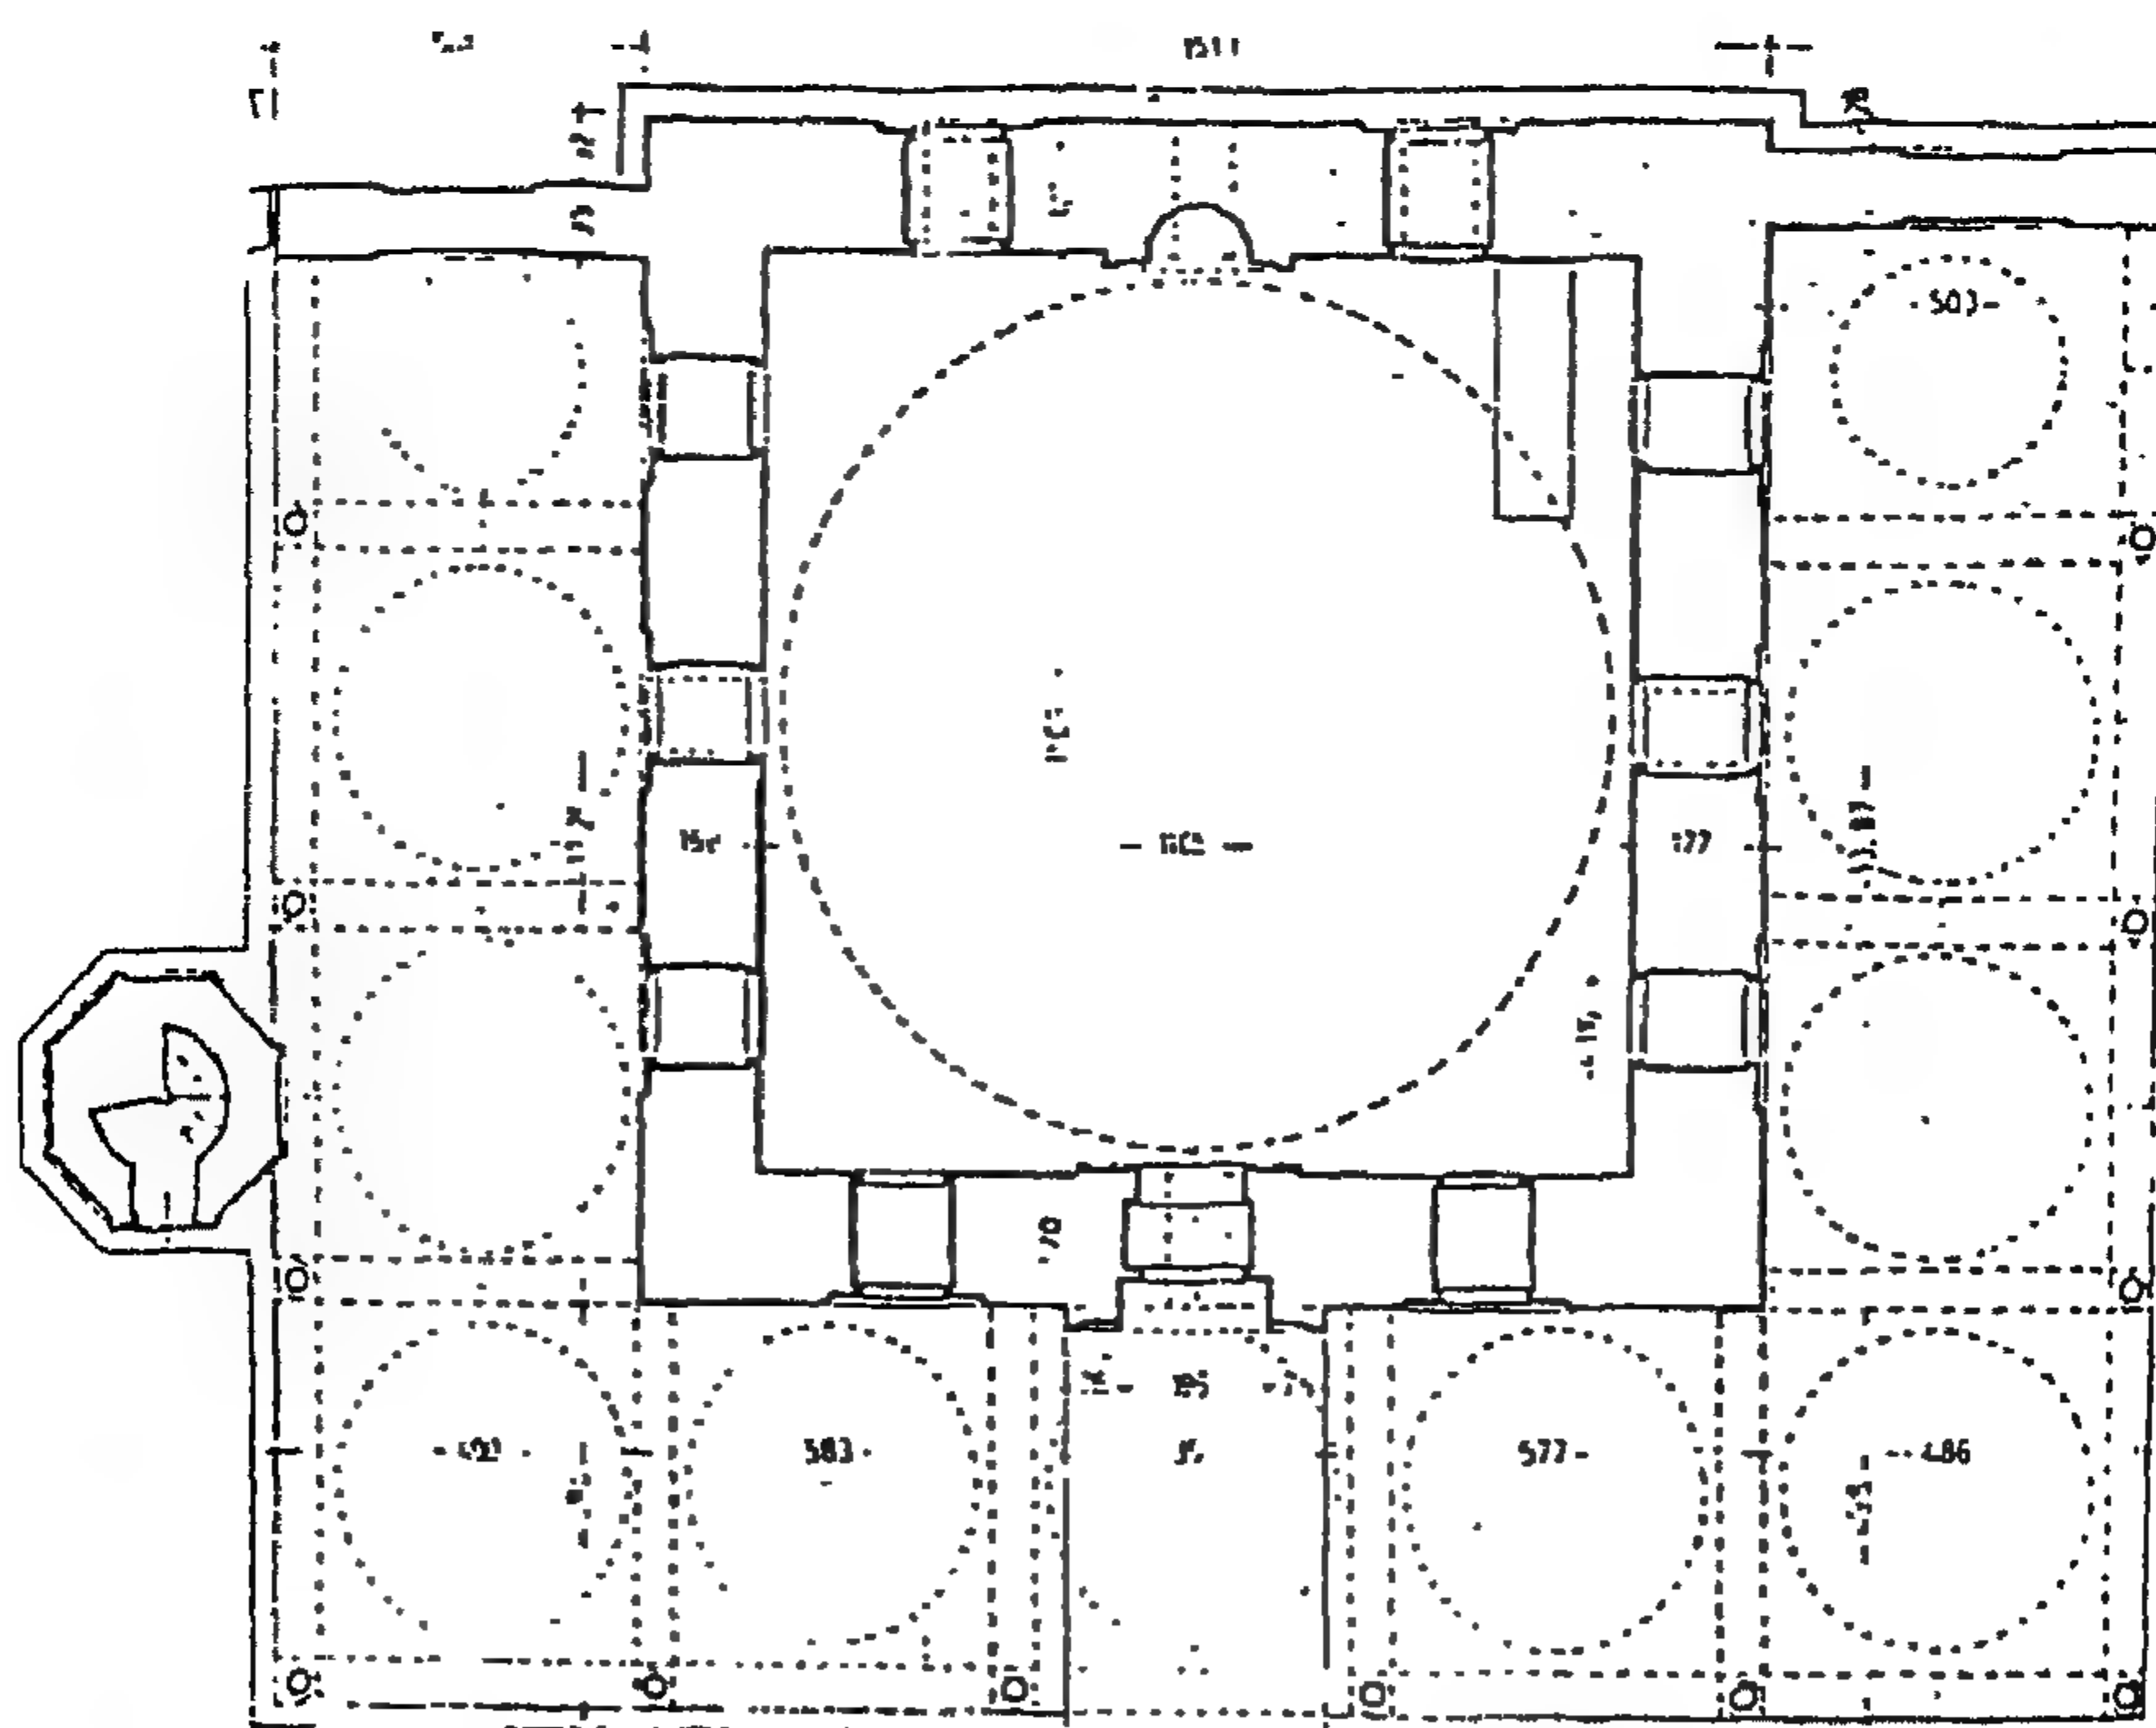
مسقط أفقي لمسجد الشيخ لطف الله (الطابق الثاني)
